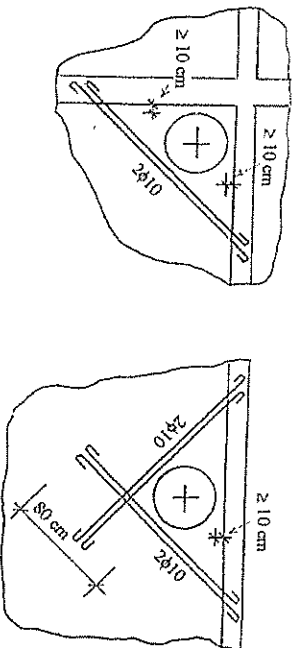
Reforço de abertura em lajes armadas em duas direções
